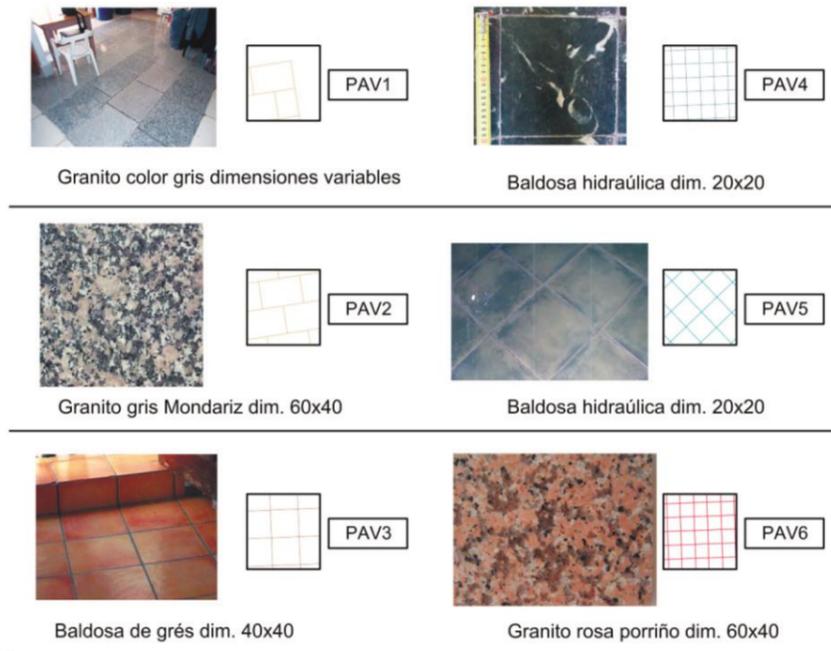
Pavimentos existentes en planta baja Fuente: Propia
